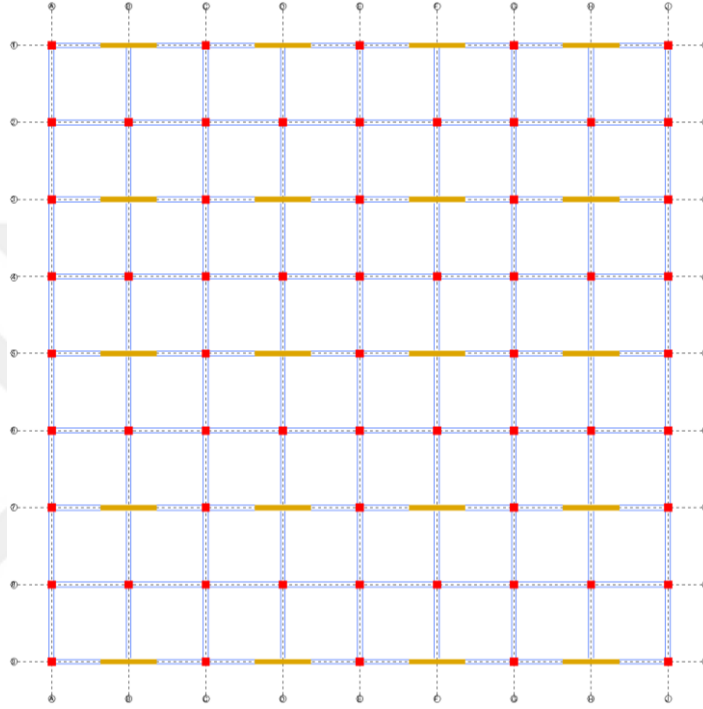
Model 7.5 'e Ait Kat Planı
